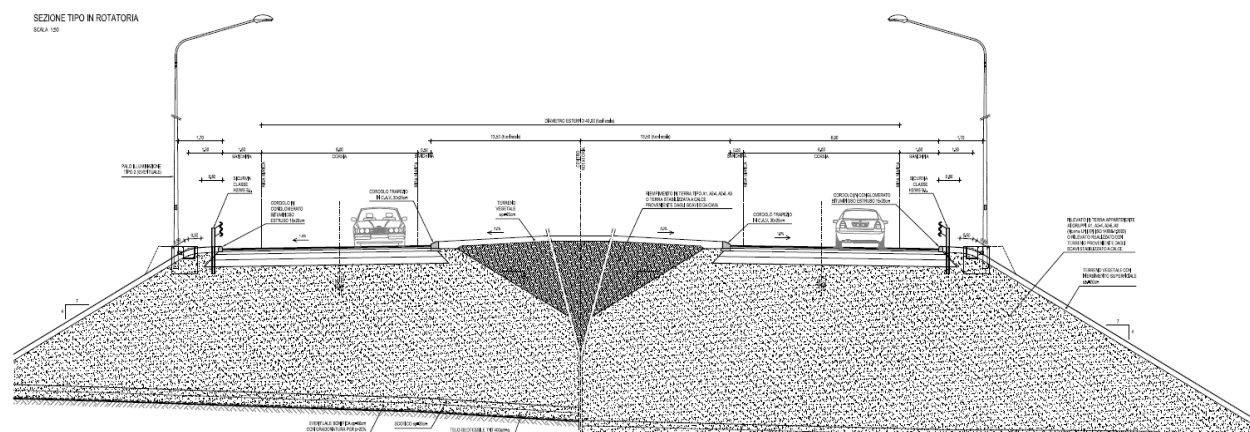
Esempio di sezione trasversale tipica di rotatoria
